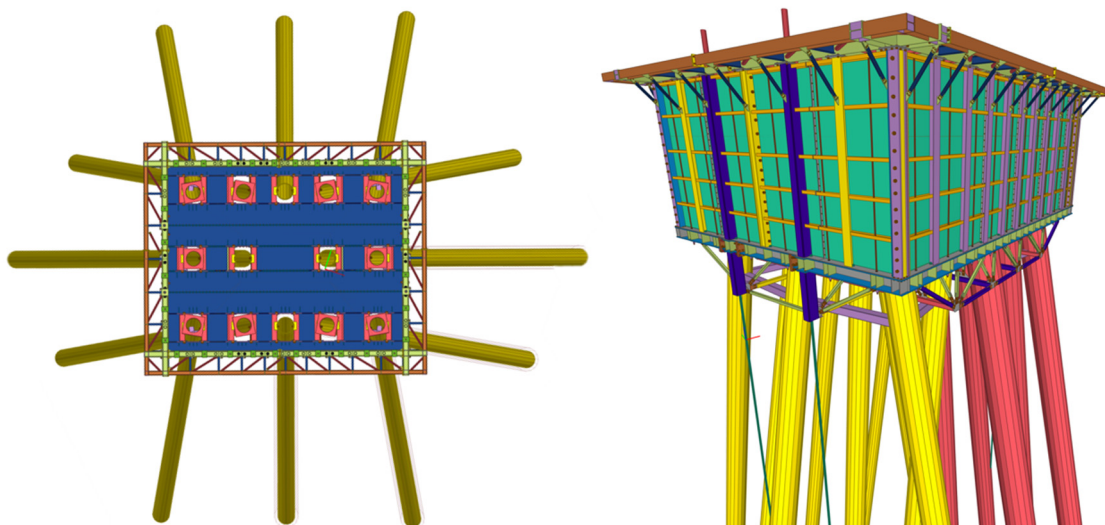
Kofferdammkonstruktion mit Pfahlausteilung
